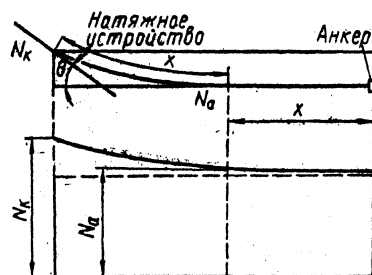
Схема изменения усилий в напрягаемой арматуре криволинейного очертания для определения потерь предварительного напряжения при трении о стенки канала или поверхность бетона конструкции.
